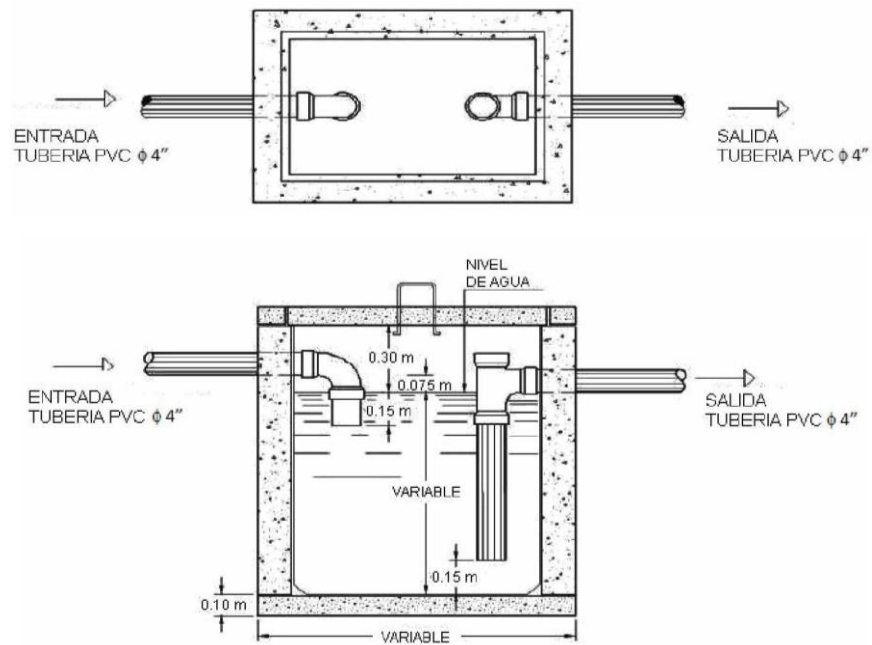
Esquema en planta y sección de una trampa para grasas
